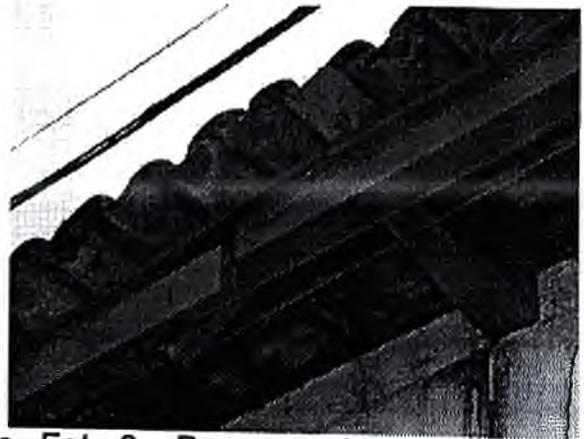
Arruinamento no interior do prédio Foto 8 – Peça rompida da cobertura
